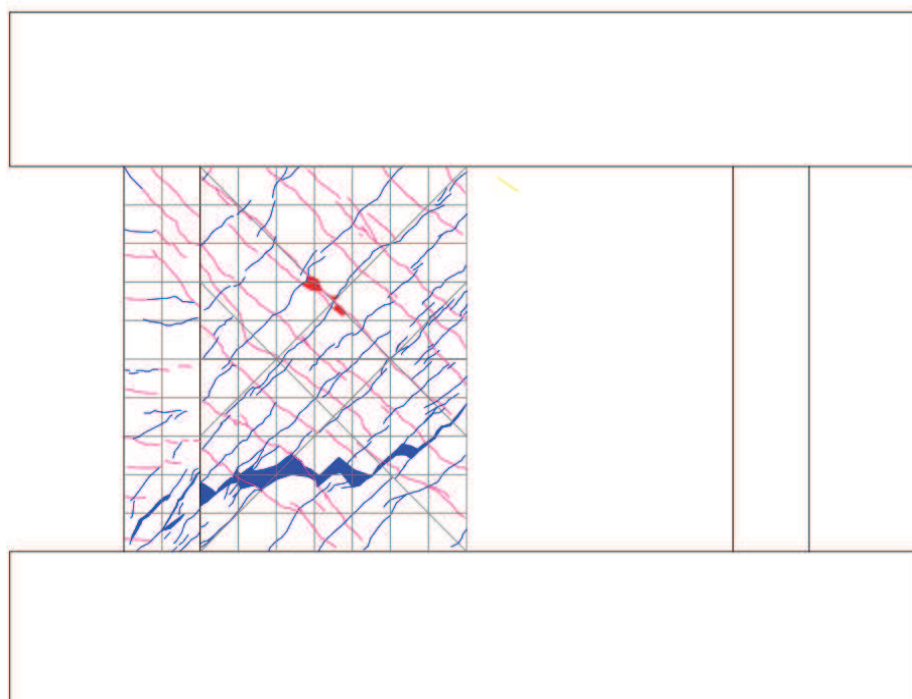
試験体 S-06-DIV 最終破壊時ひび割れ図
